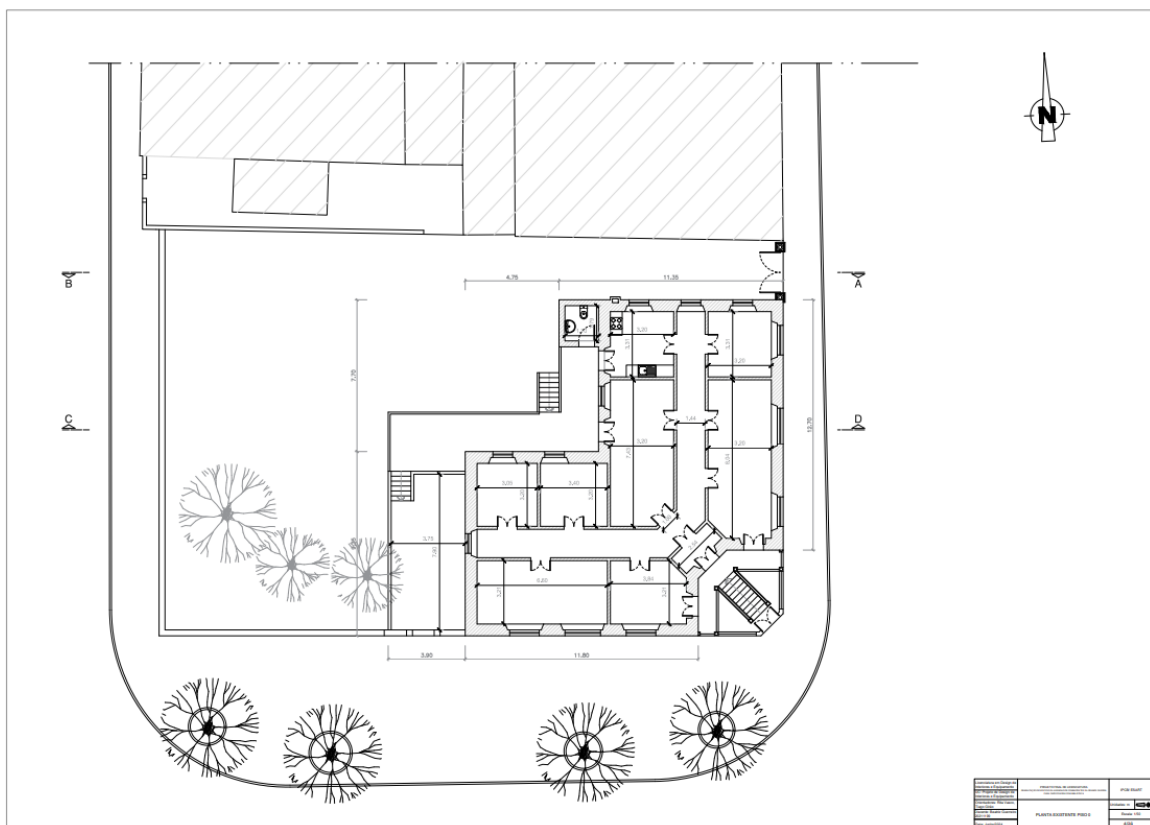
Planta existente piso 0, sem escala. Fonte: Autor
